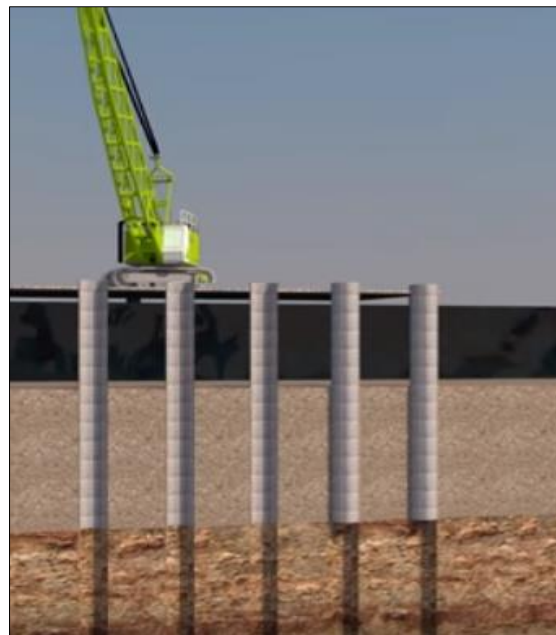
Pilas de socalzado. *FUENTE: RENDER ARQUITECTURA & URBANISMO.
